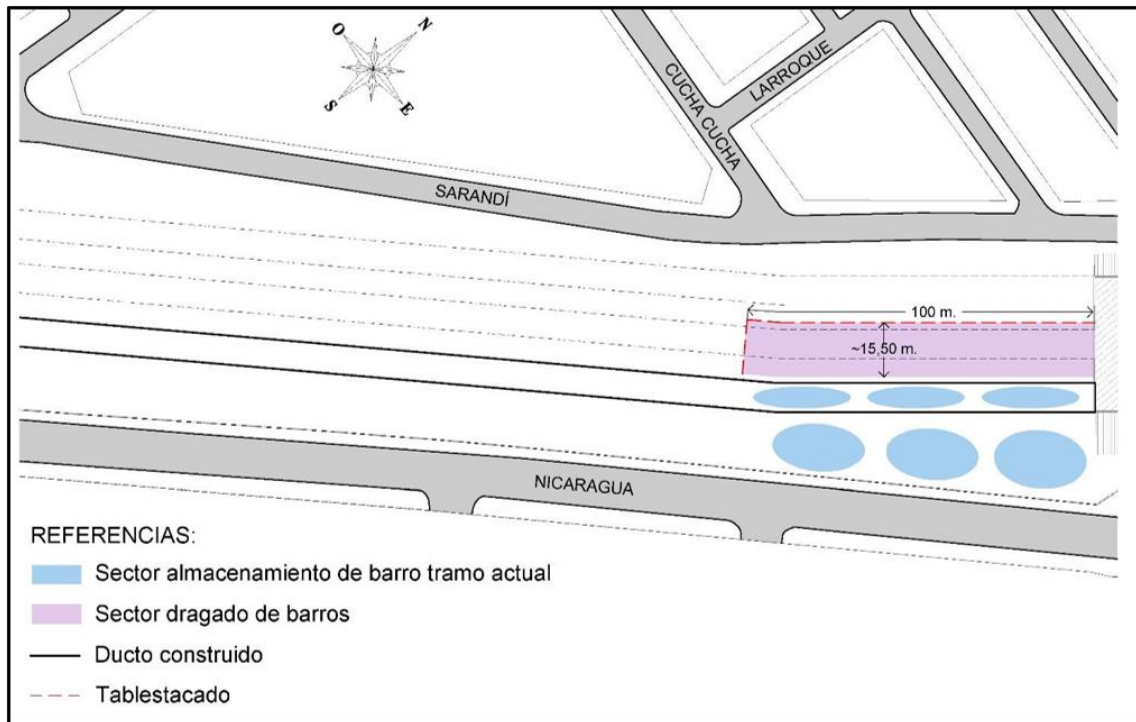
Primer tramo de conducto 2 – Dragado y almacenado de barros.
